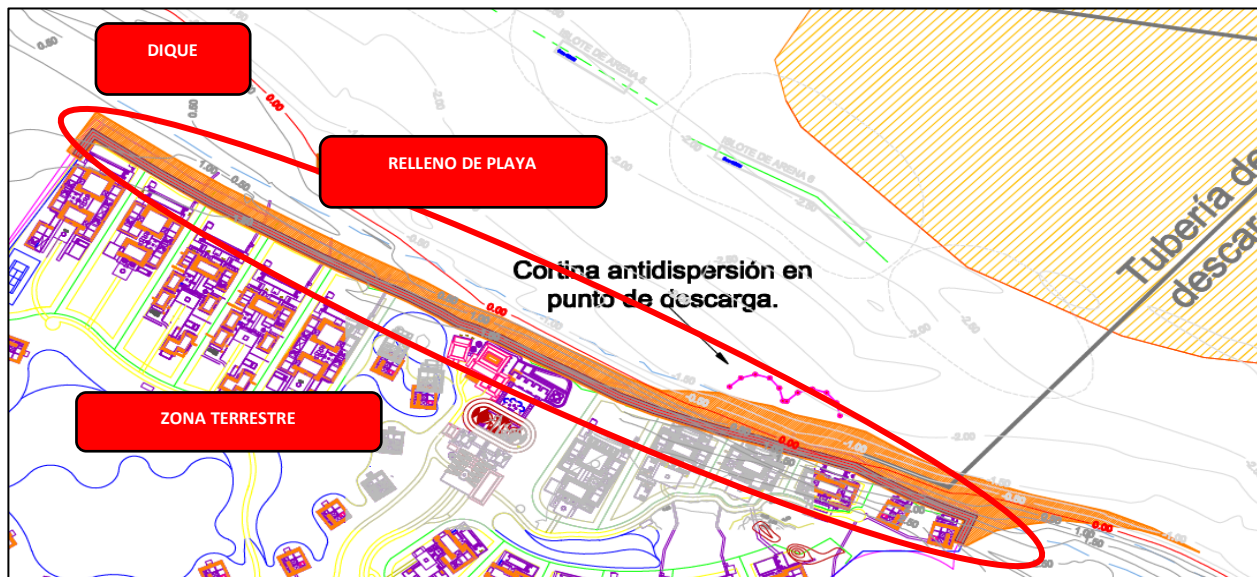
Representación de la superficie terrestre que ocupará el relleno de playa y la construcción del dique en la zona terrestre AMAN/Mixta,
